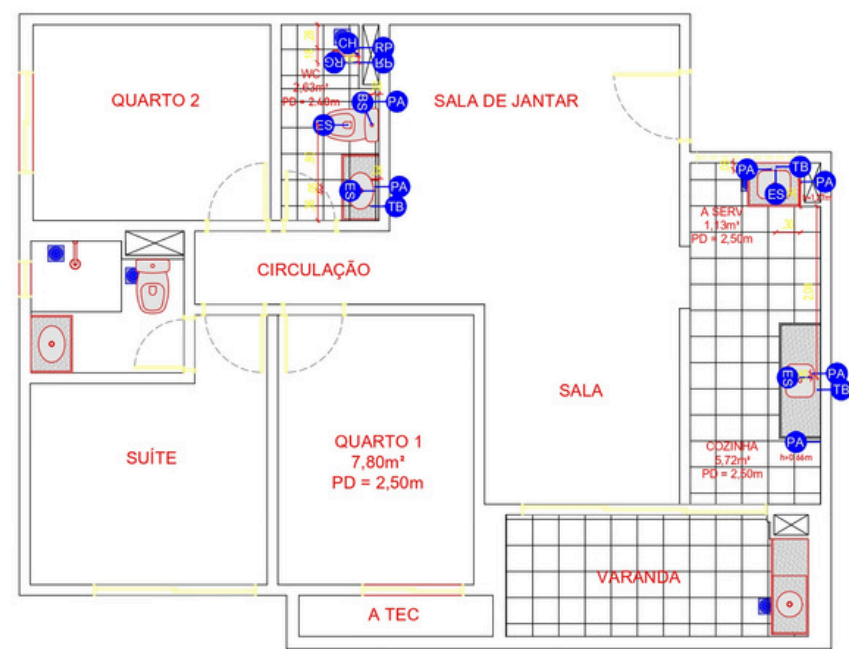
Imagem do AutoCad com a planta de pontos elétricos do imóvel escolhido.
